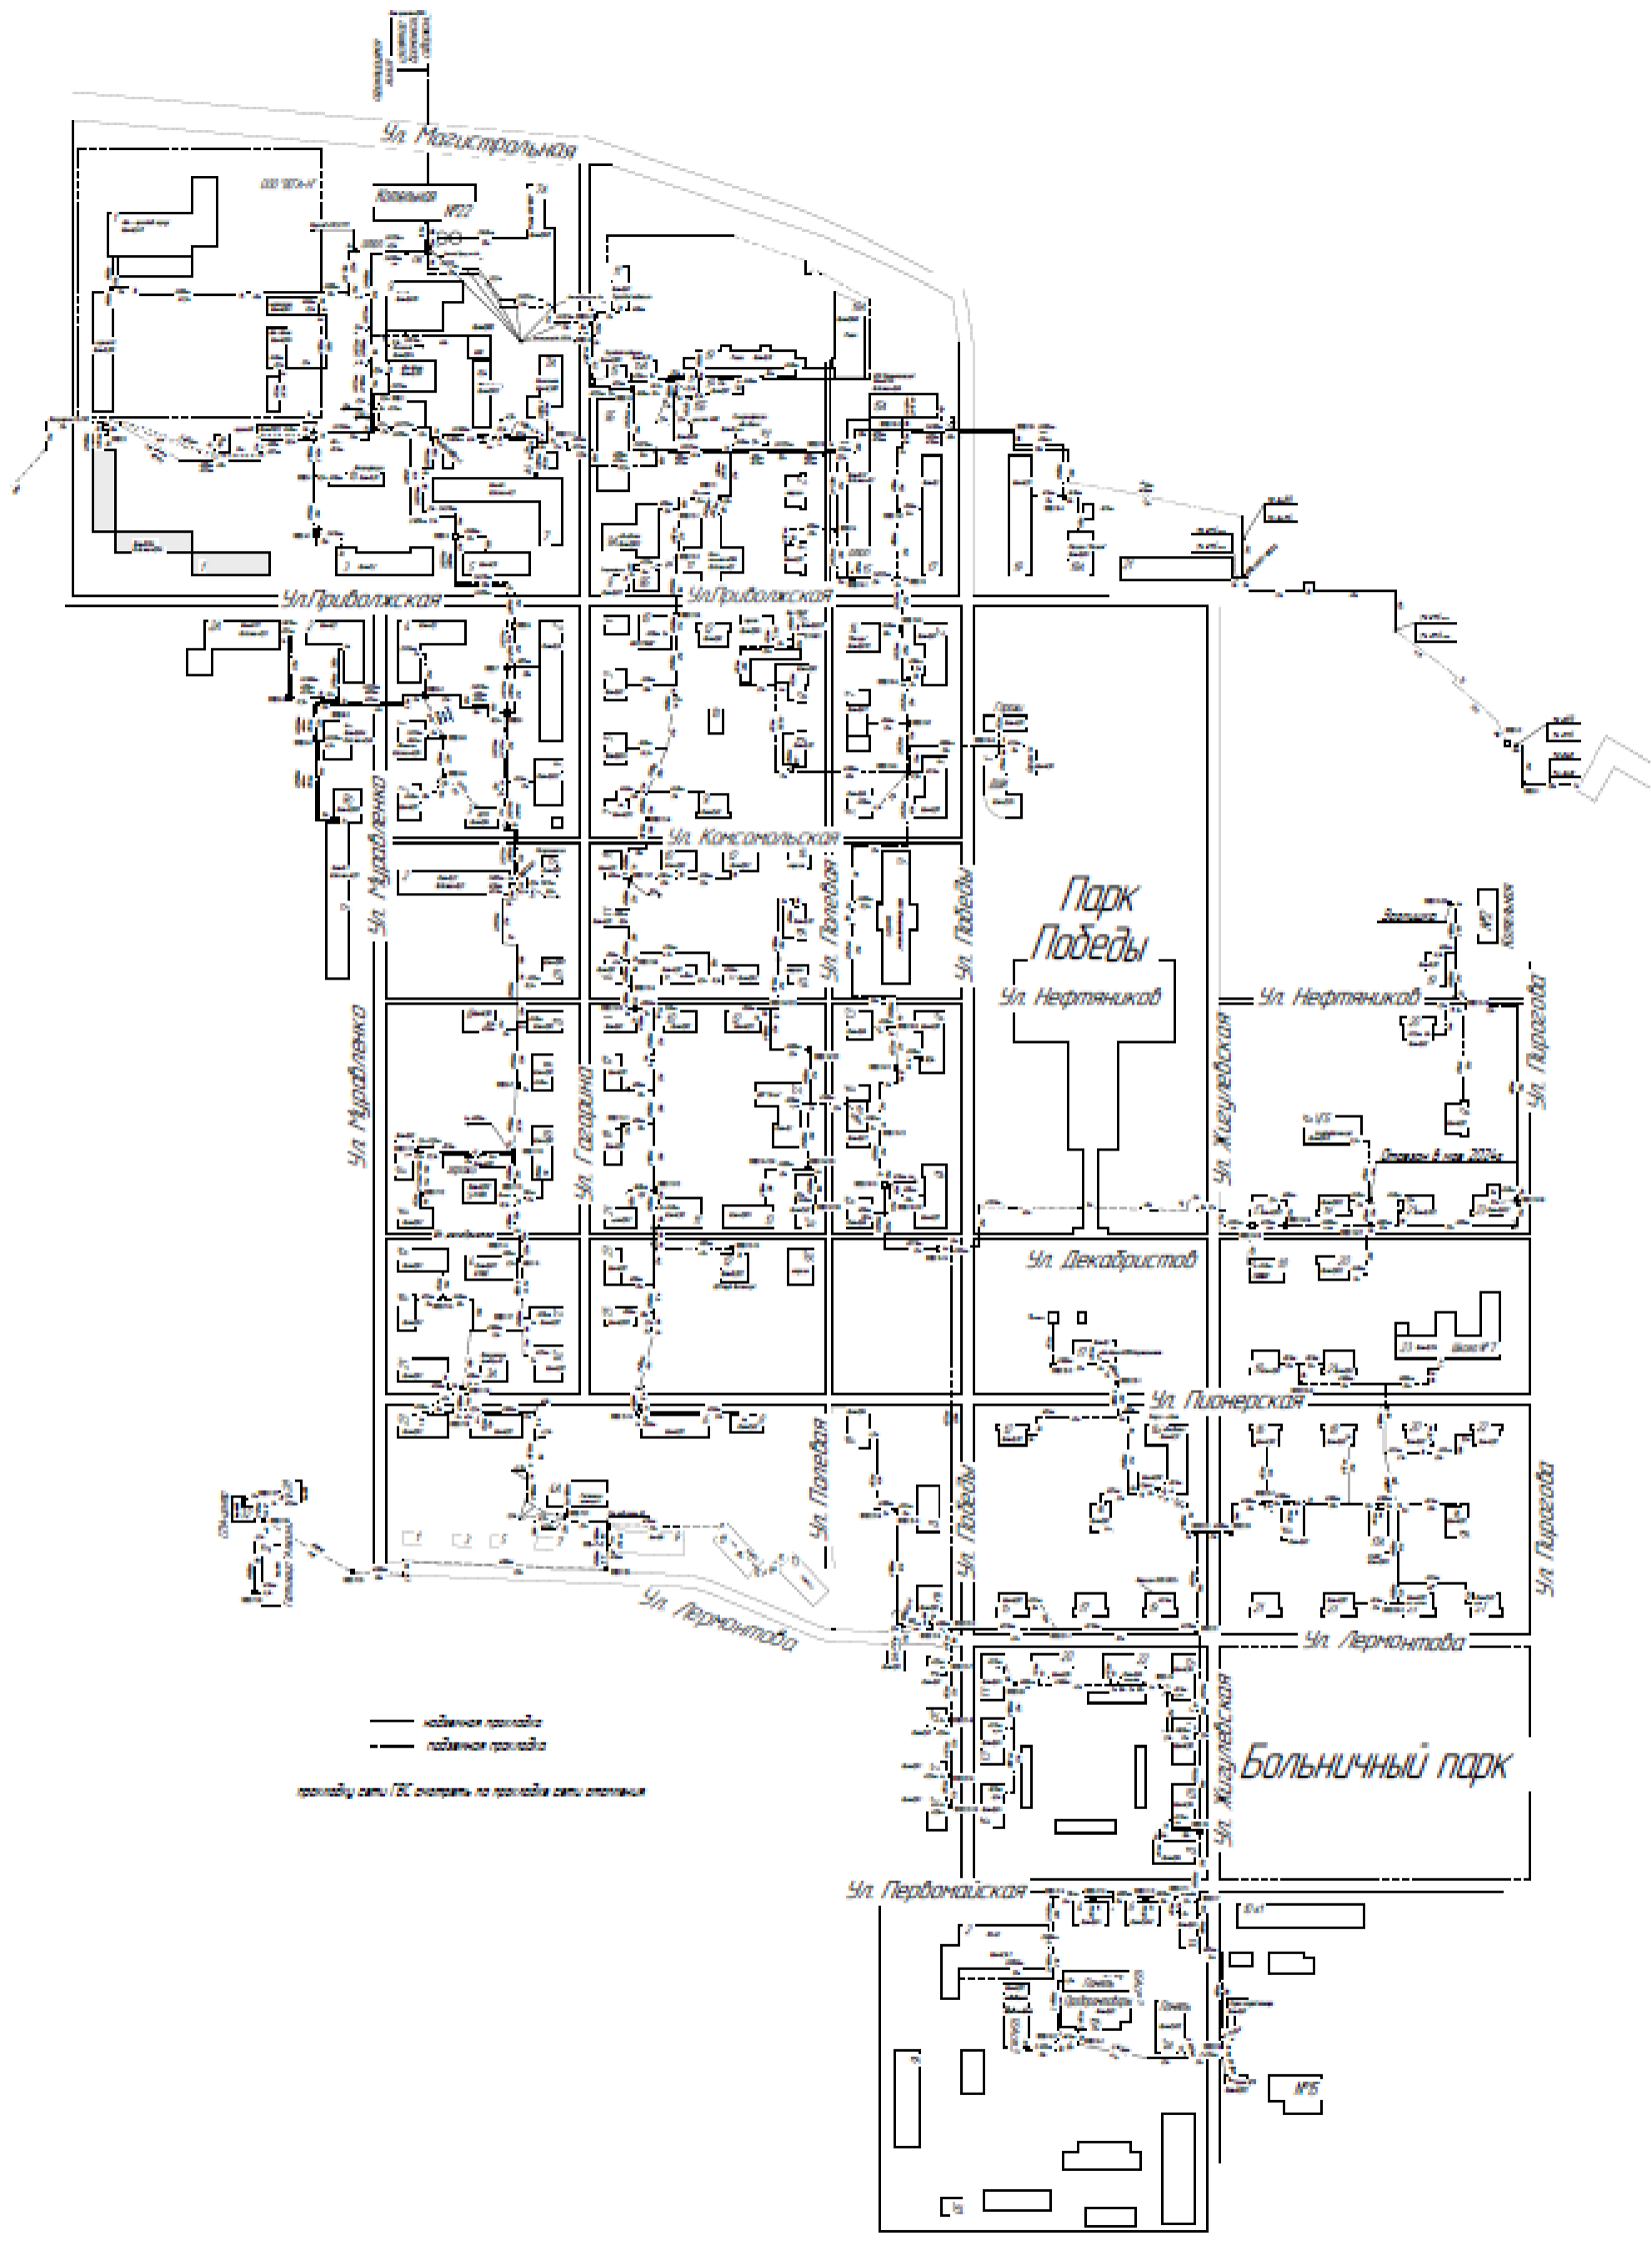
Схема тепловых сетей от котельной №22
